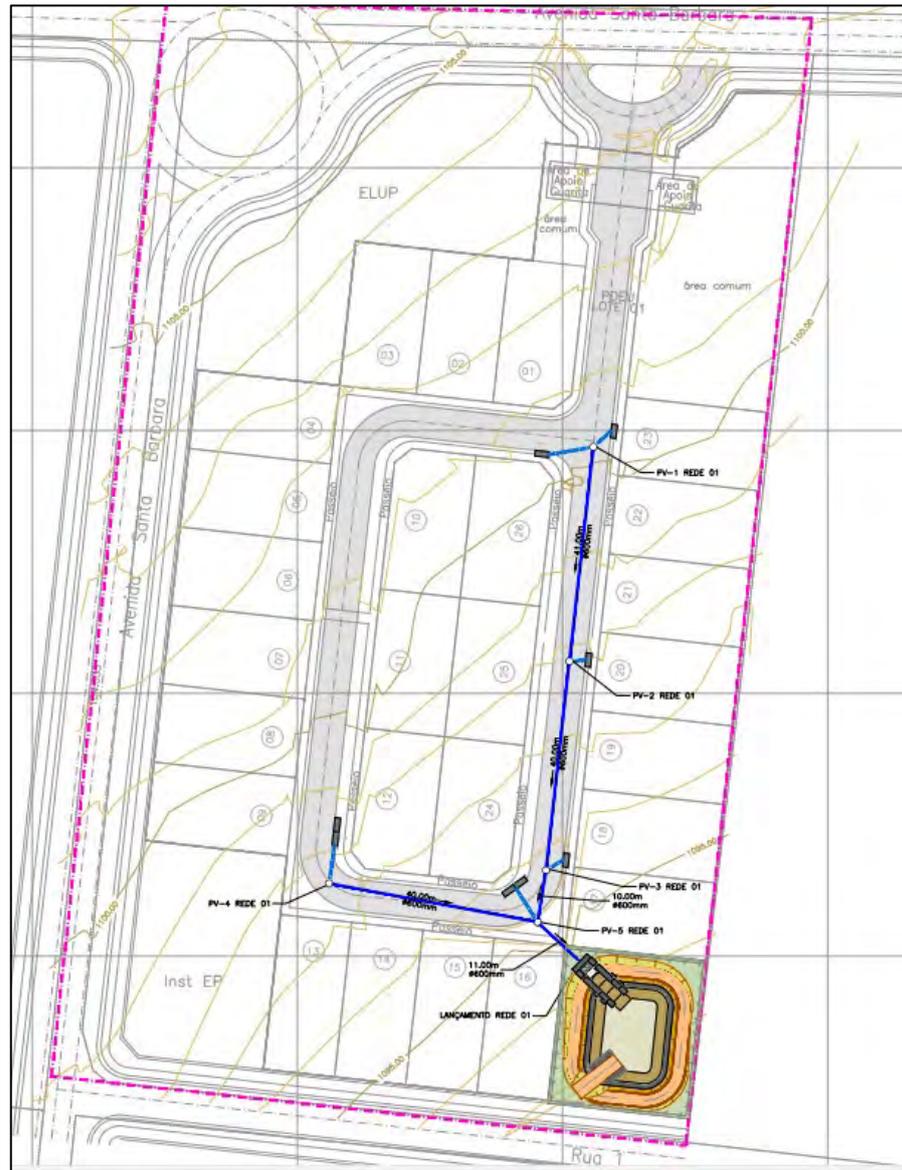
Planta Geral do Projeto de Drenagem. Fonte: Autor.
